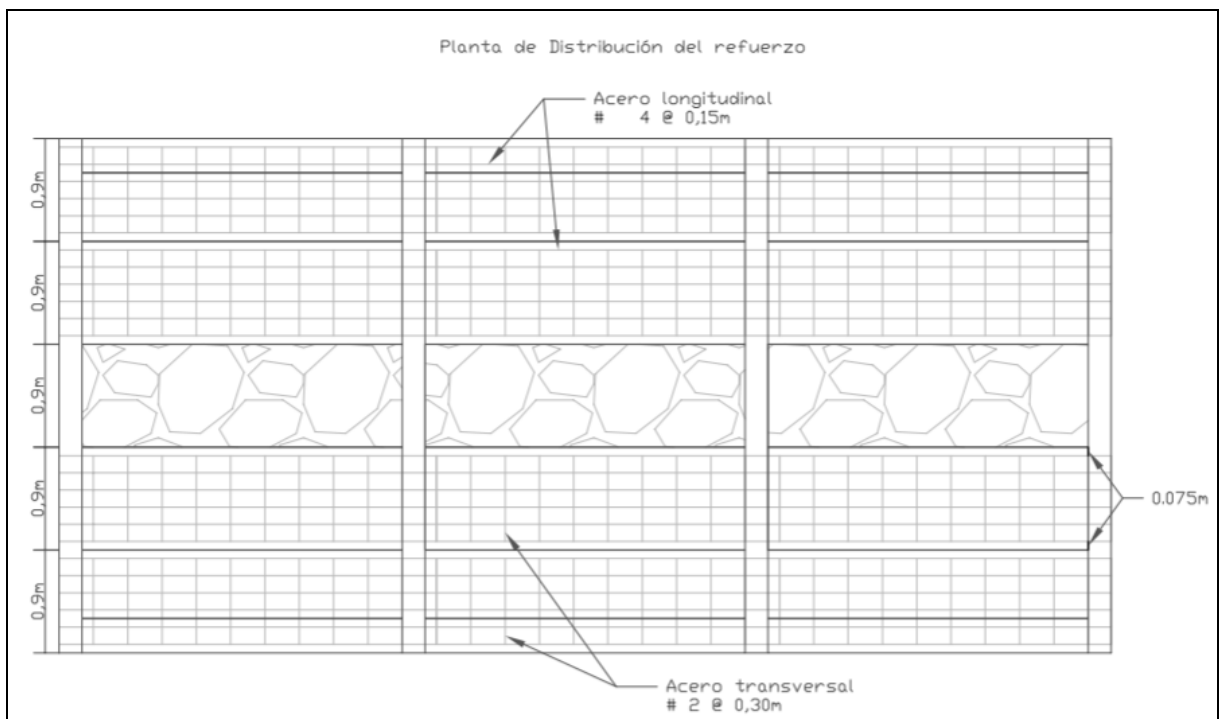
Esquema en planta modificado de la distribución del refuerzo.
